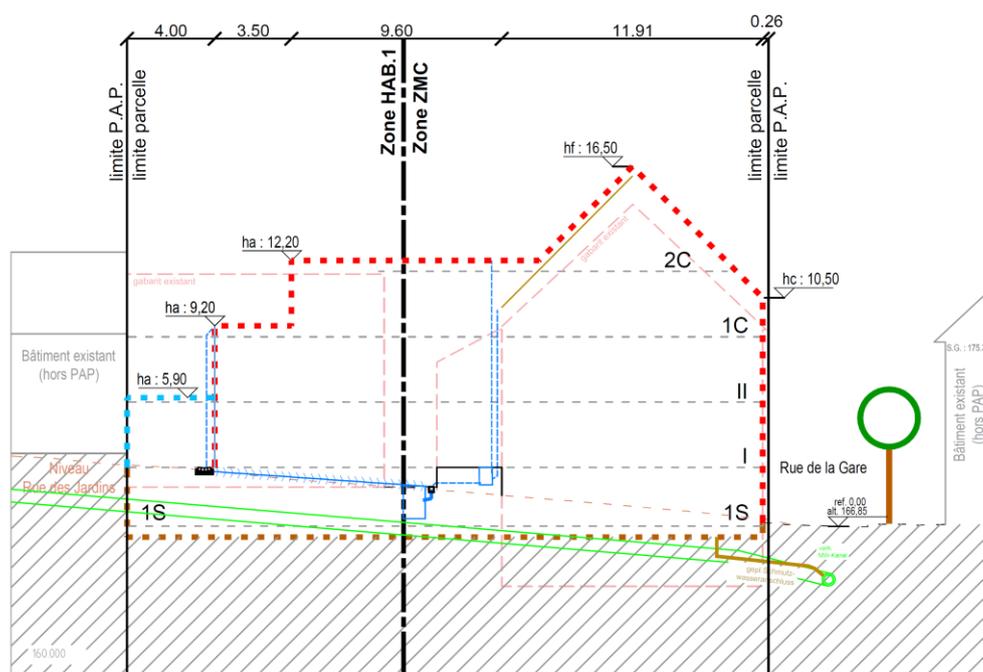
Coupe C-C du PAP. (Source : BEST)
